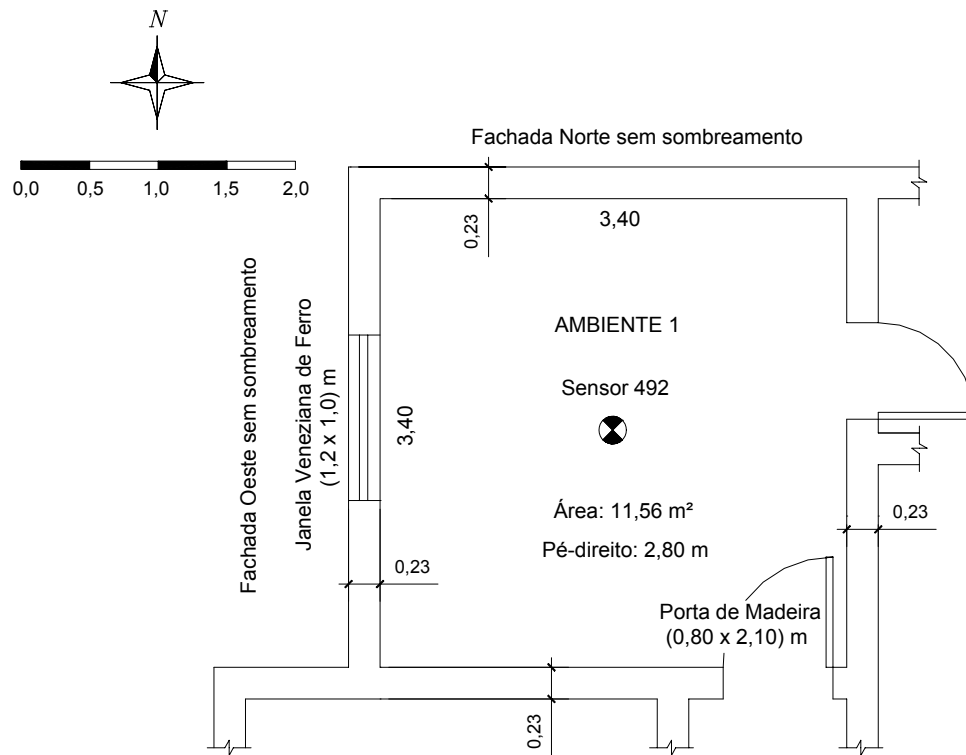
Planta baixa do ambiente monitorado – Edificação 1.
